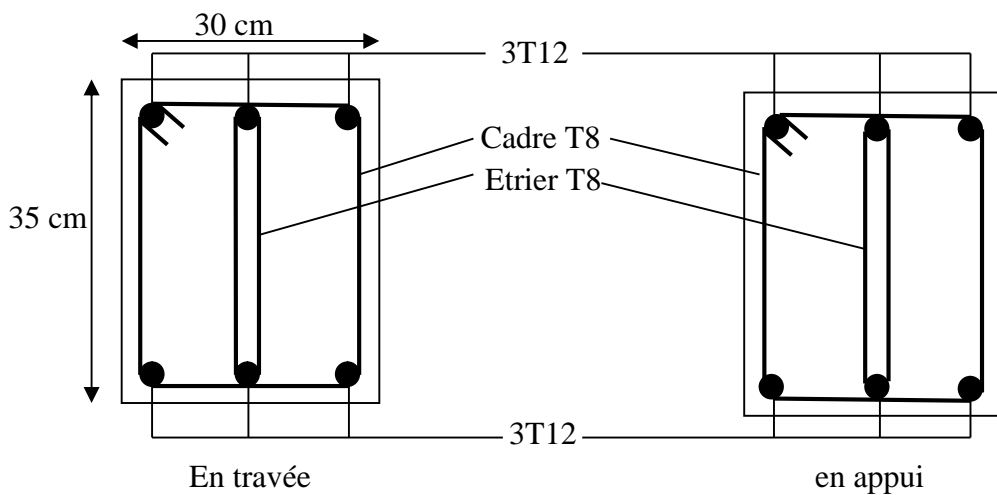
Schéma de ferrailage de la poutre secondaire RDC
